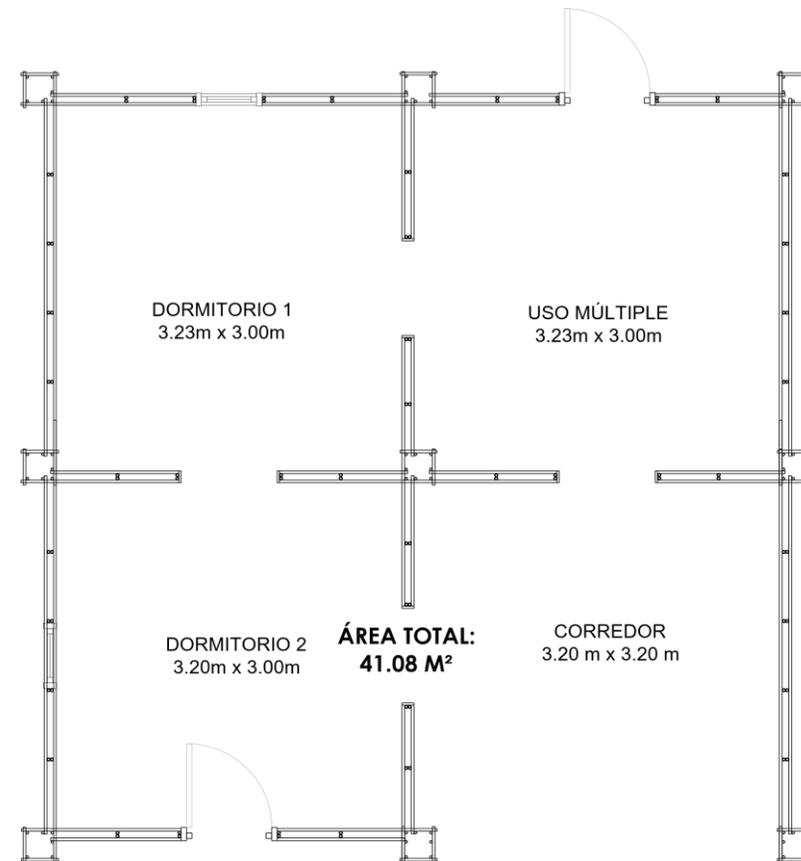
Planta tipo para vivienda de interés social con sistema constructivo bahareque cerén. Fuente: FUNDASAL.
